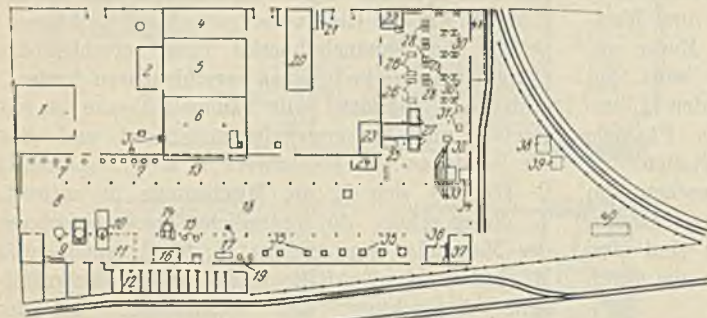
Grundriß der Sivyer Stahlgießerei.
